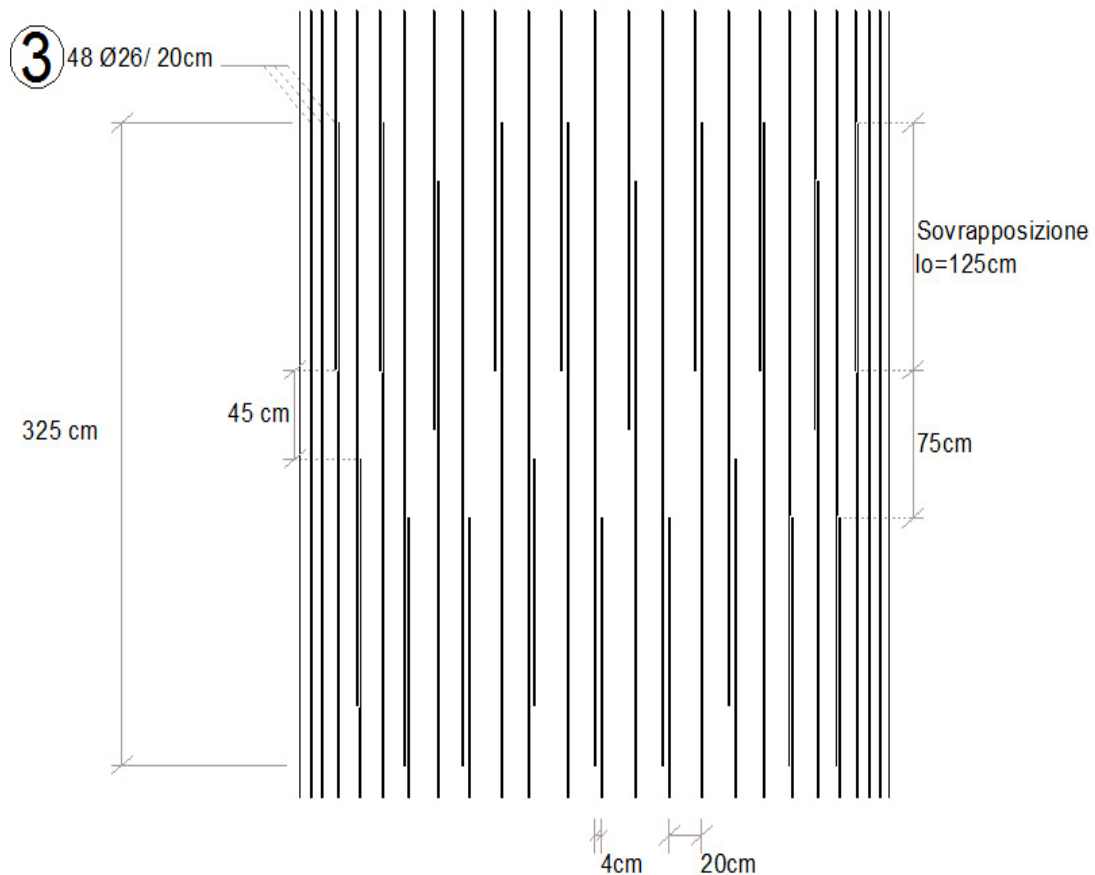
Dettaglio di sovrapposizione delle barre longitudinali, pile isolate, $\phi 26$.
